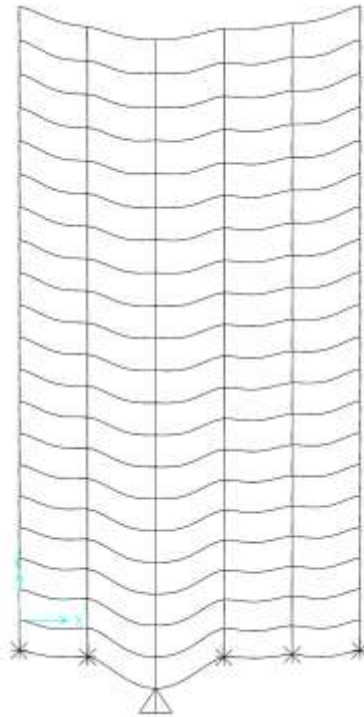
Deformadas – Corte Longitudinal passando pela Viga V7 – Caso 3 – Sem o vento
